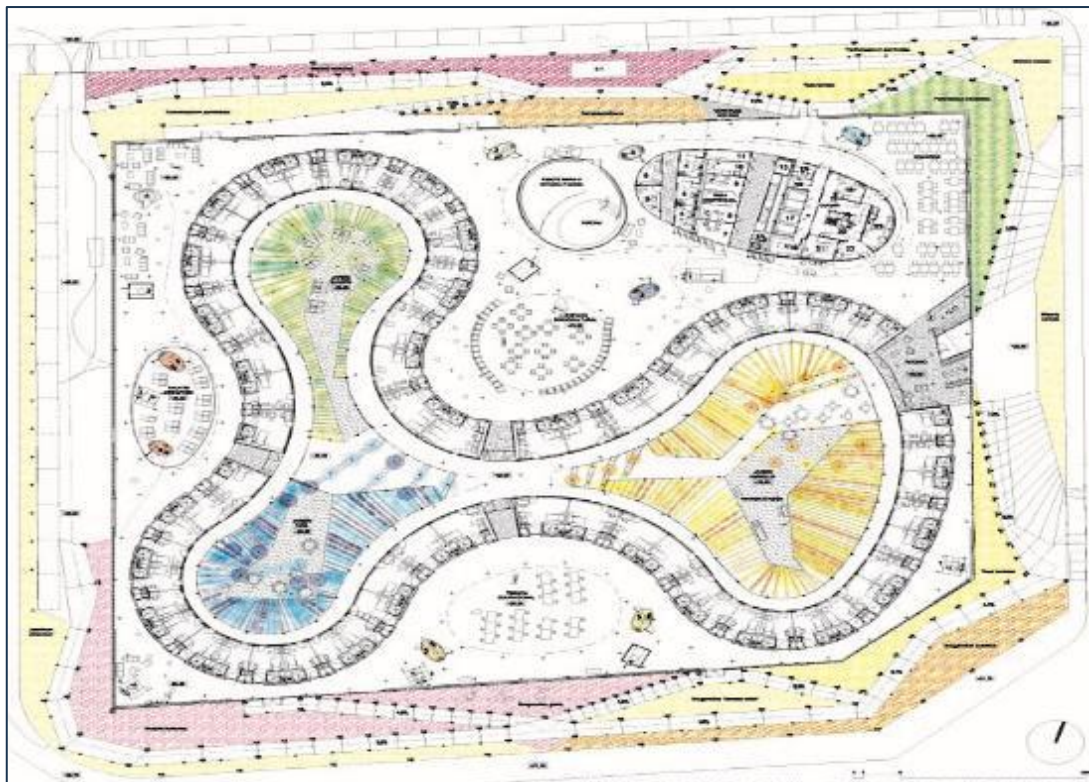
Plano del Centro Geriátrico Santa Manuel.
